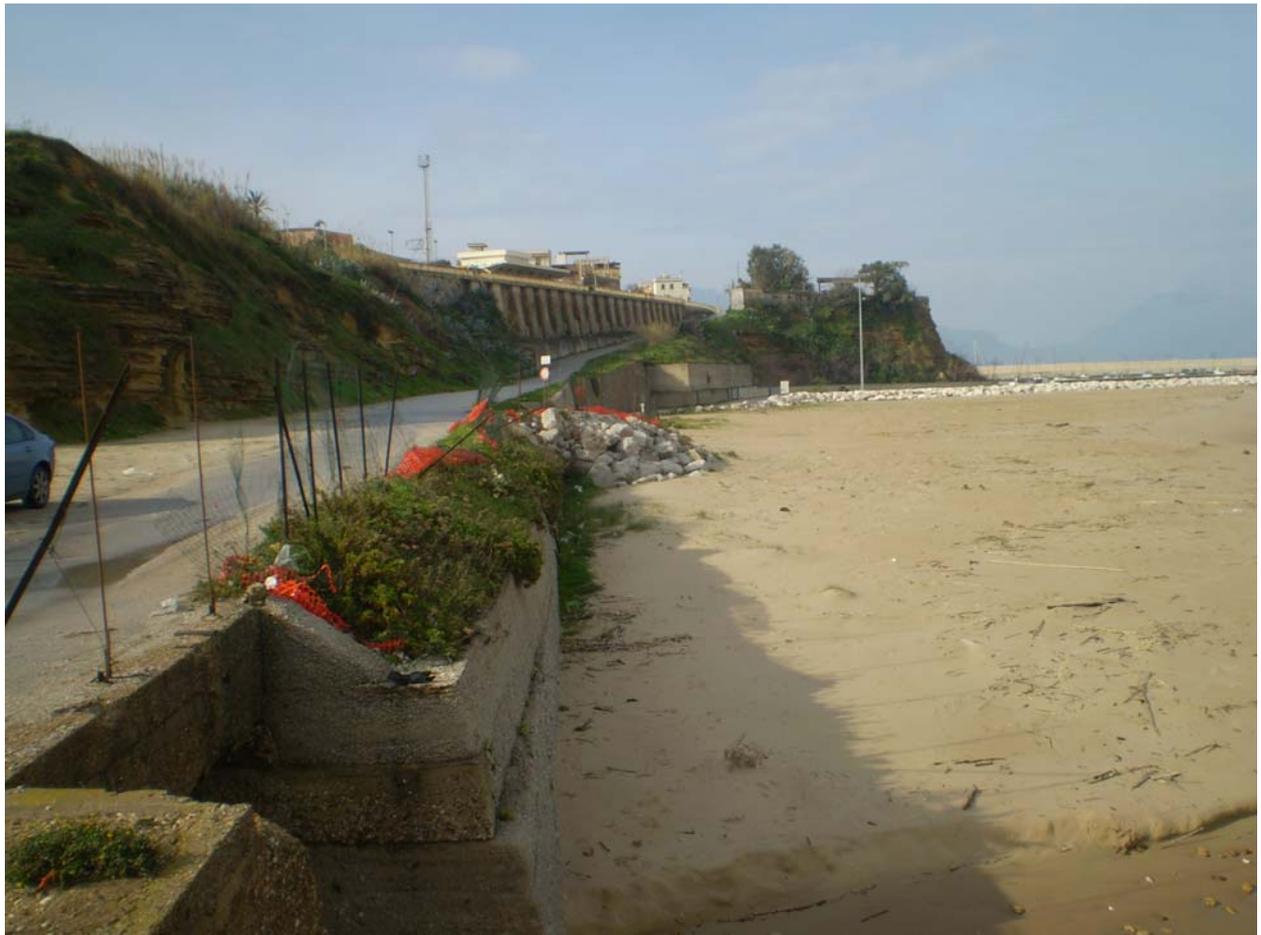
Stato futuro area intervento (fotoinserimento)
